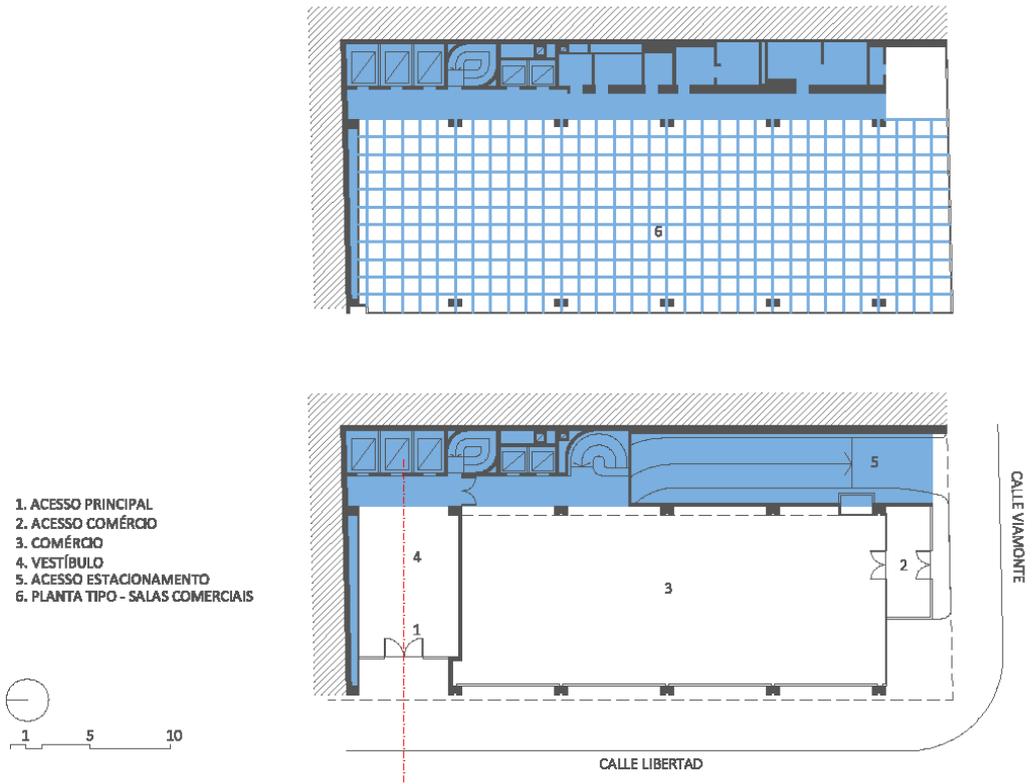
Planta Térrea e Planta Tipo, Edifício Libertad, 1971-1978.
